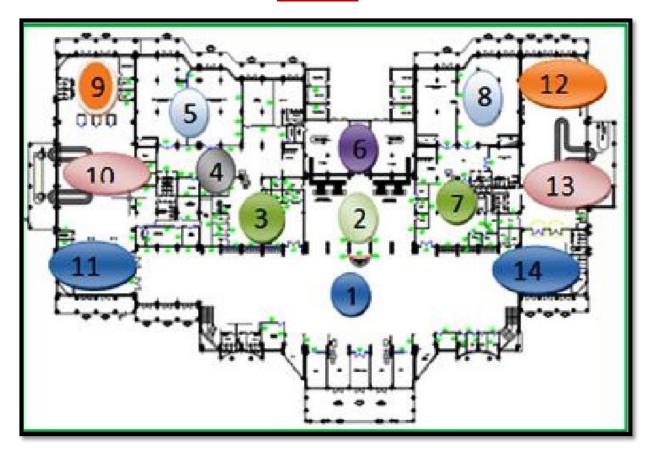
plan rez-de-chaussée de l'aérogare passager
